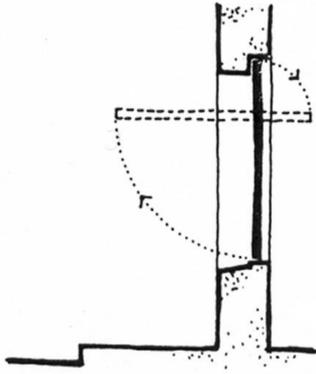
Portadas de madeira completamente opacas, asseguram protecção total contra as radiações solares directas e difusas; completamente fechadas impedem qualquer ventilação
